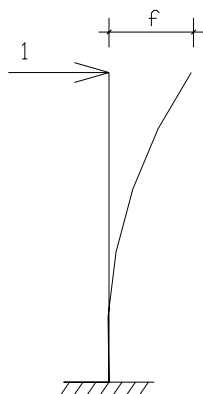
Configuração do pilar para cálculo da flexibilidade e rigidez do pilar
